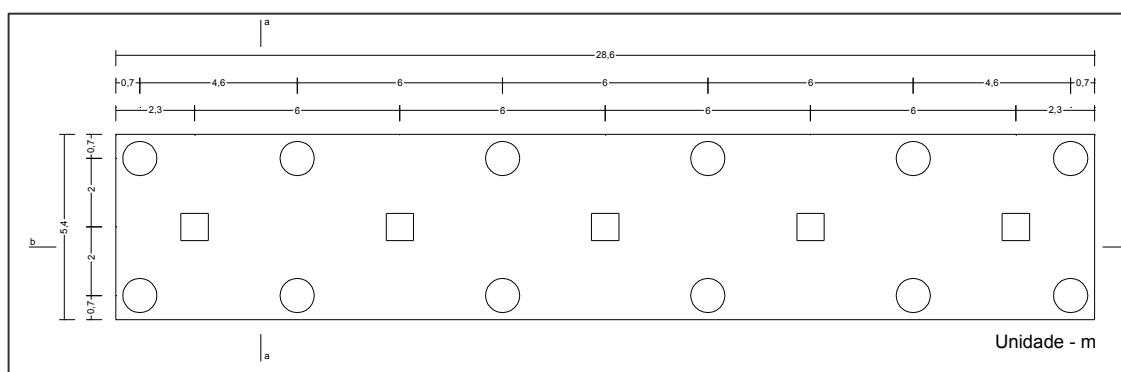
Planta do reforço das fundações dos pórticos 5, 6, 7, 9, 12, 13, 14 e 15. Desenhado a partir de (Proman, 1989).
